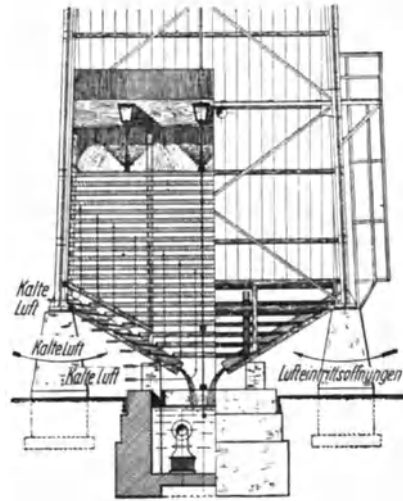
Kaminkühler mit Treppenrost-Luftzuführung.
